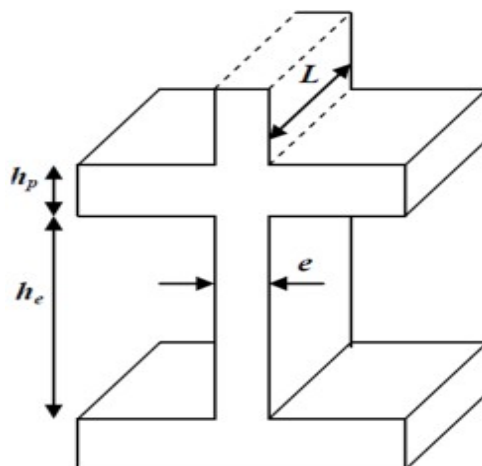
Coupe d'un voile de contreventement en élévation.[2]
